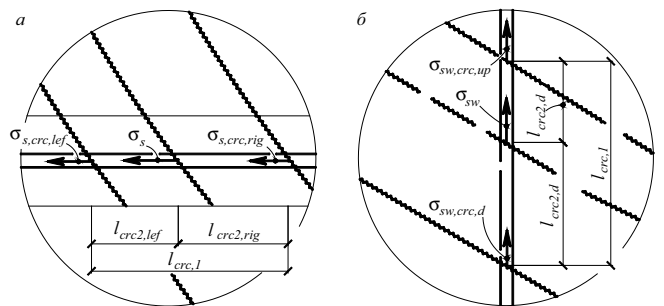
Расположение смежной трещины последующего уровня между двумя трещинами предыдущего уровня: а – вдоль оси поперечной арматуры; б – вдоль оси продольной арматуры
